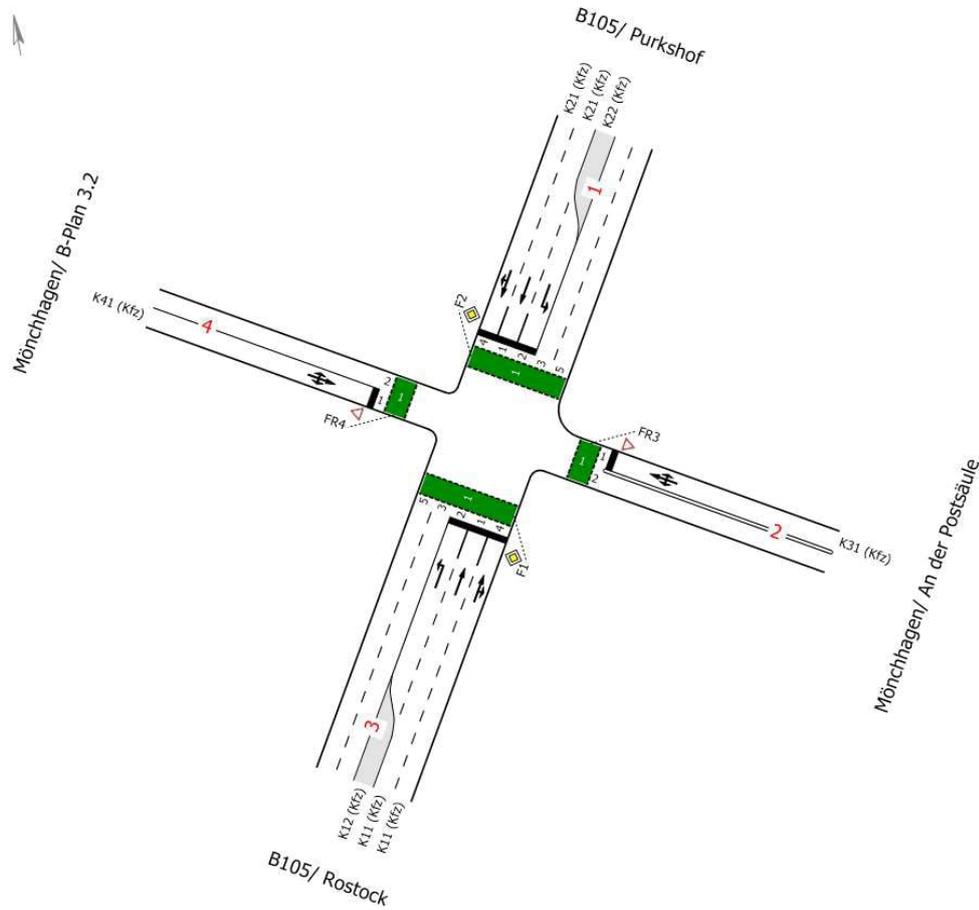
Knotenpunktschema KP6a – Plan-Ausbauzustand Planfall 1
